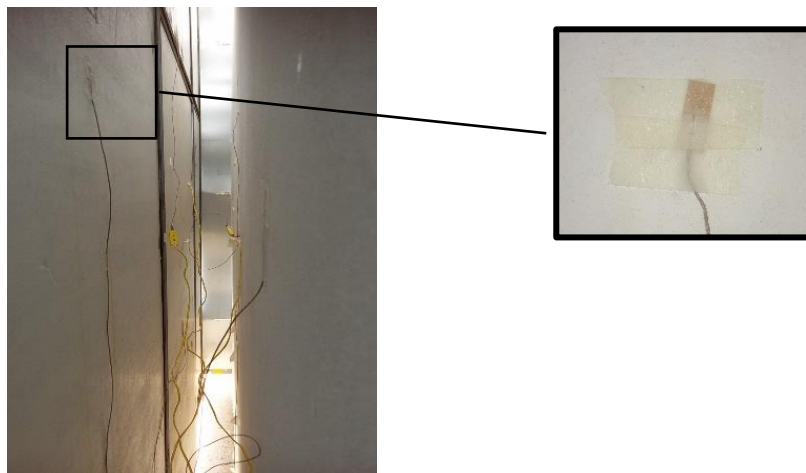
Termopares de superfície instalados na face interna da fachada e na face externa da parede do protótipo e em detalhe, a fixação de um termopar
